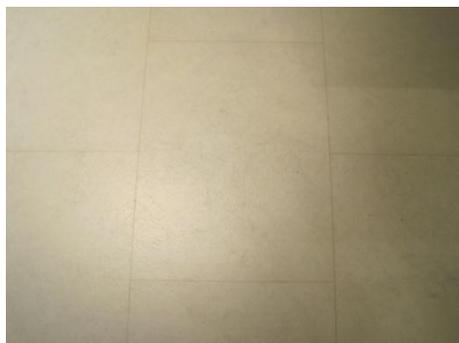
Pavimento da gama Corkcomfort colado WRT
